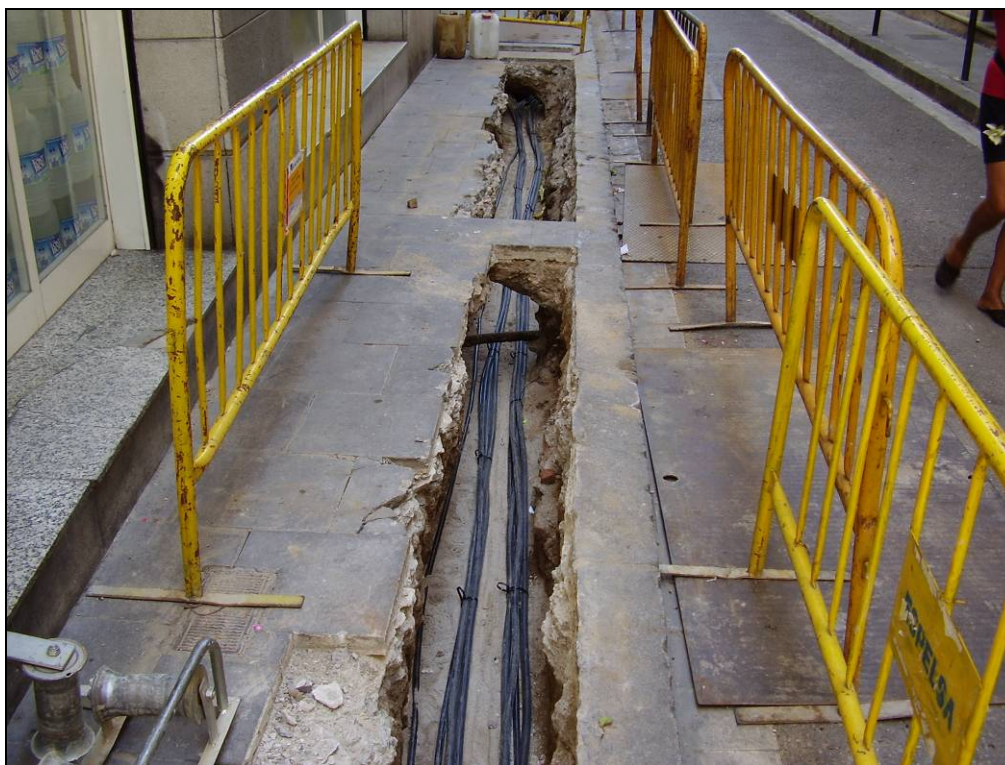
Rebaixos del sediment UE102 de la Rasa 100
